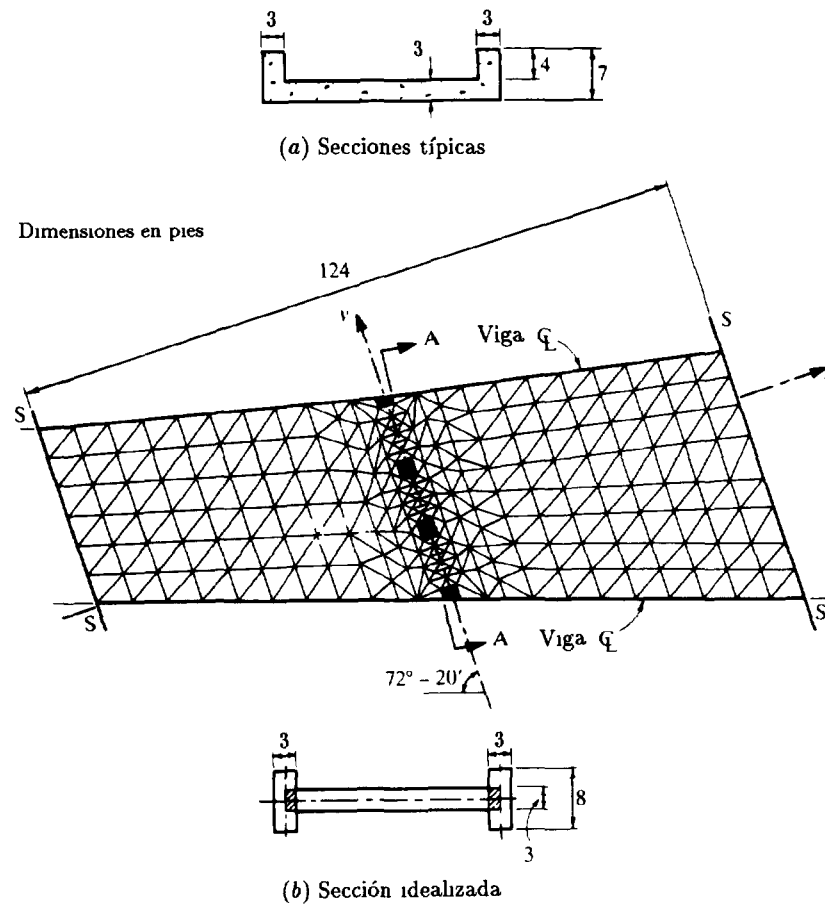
El puente de ferrocarril de Castleton. Geometría y detalles de la malla de elementos finitos.
